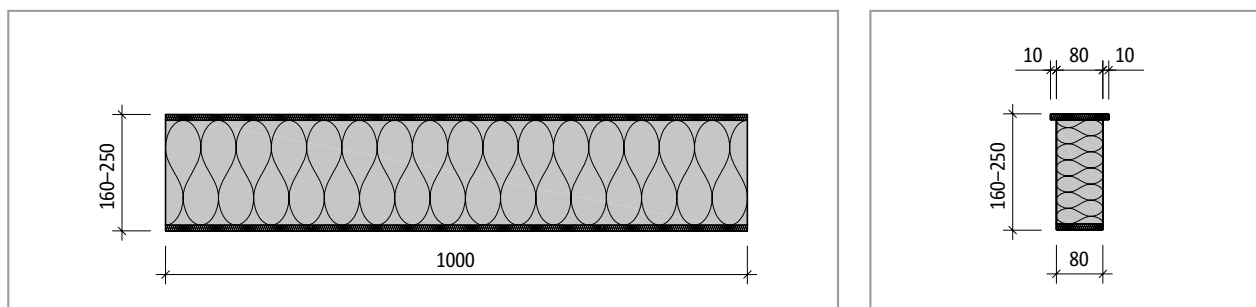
Schöck Isokorb® T tipo Z-EI120-T-L1000: Vista y sección del producto
